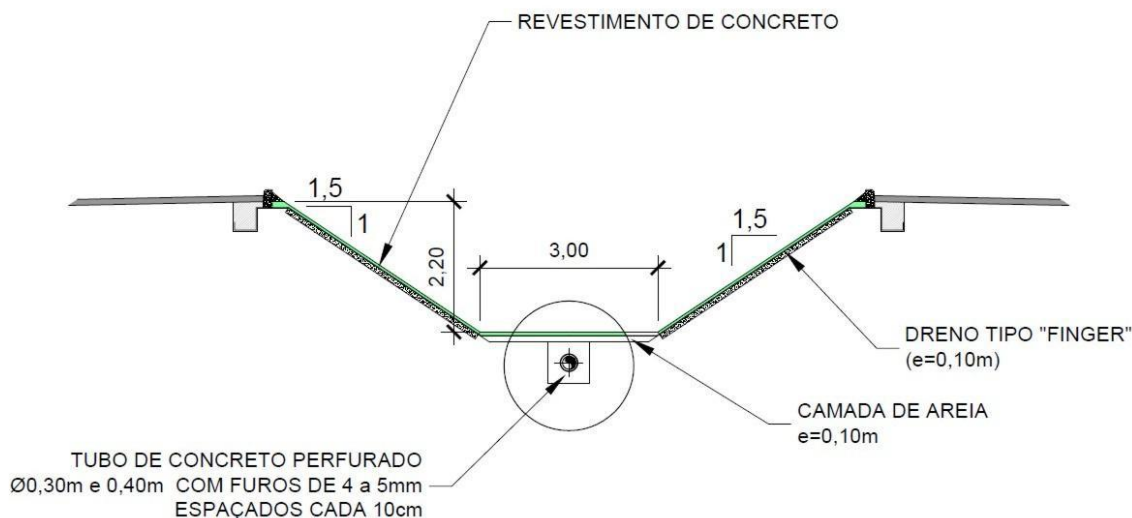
Drenagem interna nos canais. Seção Típica
